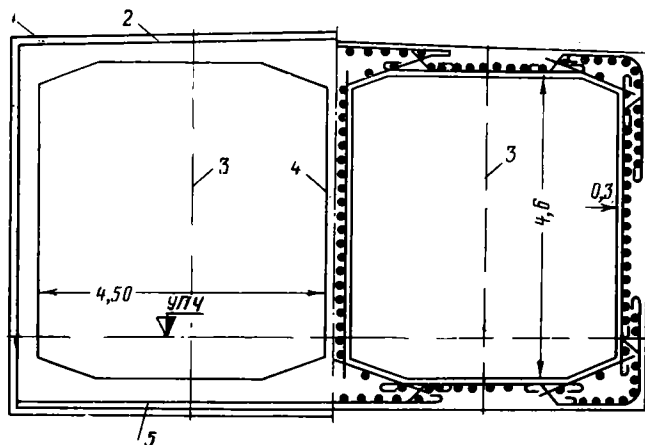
Конструкция тоннеля в виде железобетонной рамы со средней стенкой:
